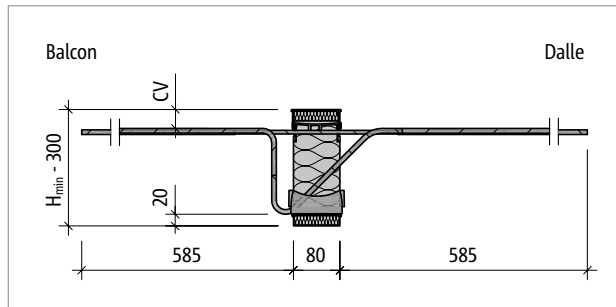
Schöck Isokorb® T type K-T-M5 : coupe du produit
